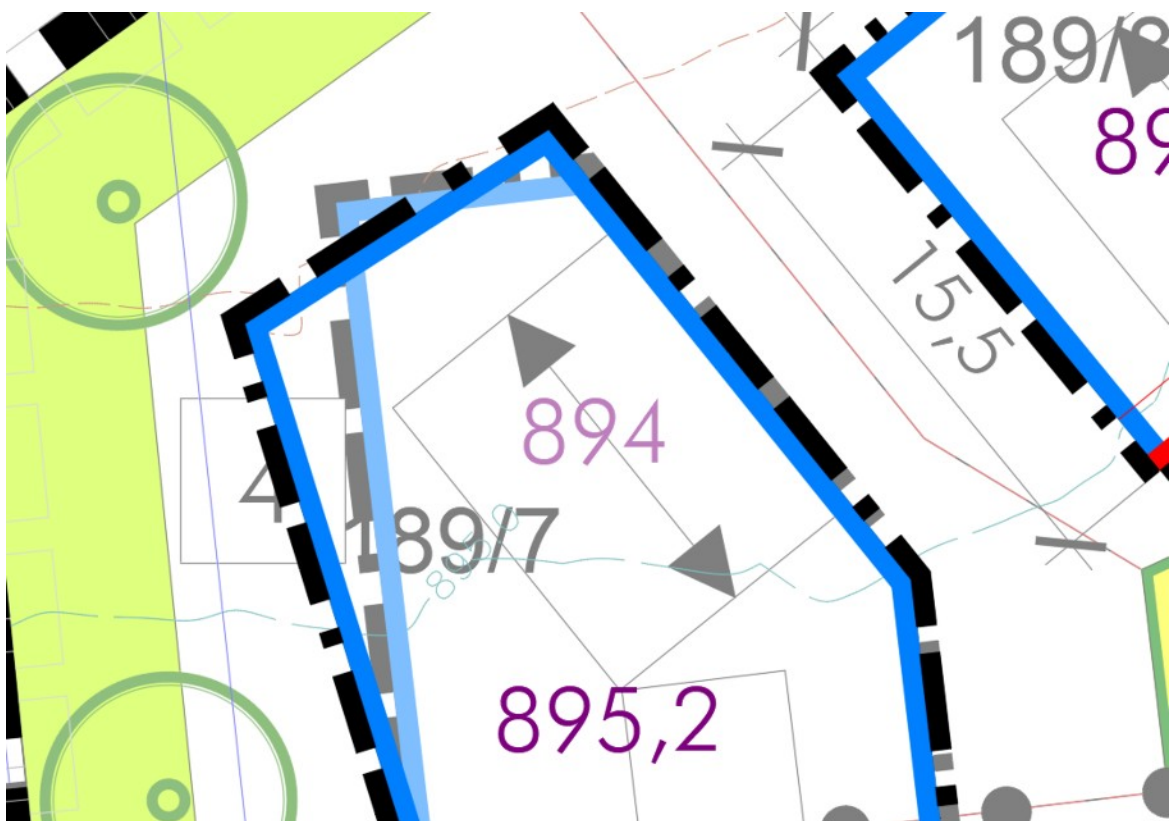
Bauplatz 4. Überlagerung der Planzeichnungen "Am Grohholz" und erste Änderung, unmaßstäblich
